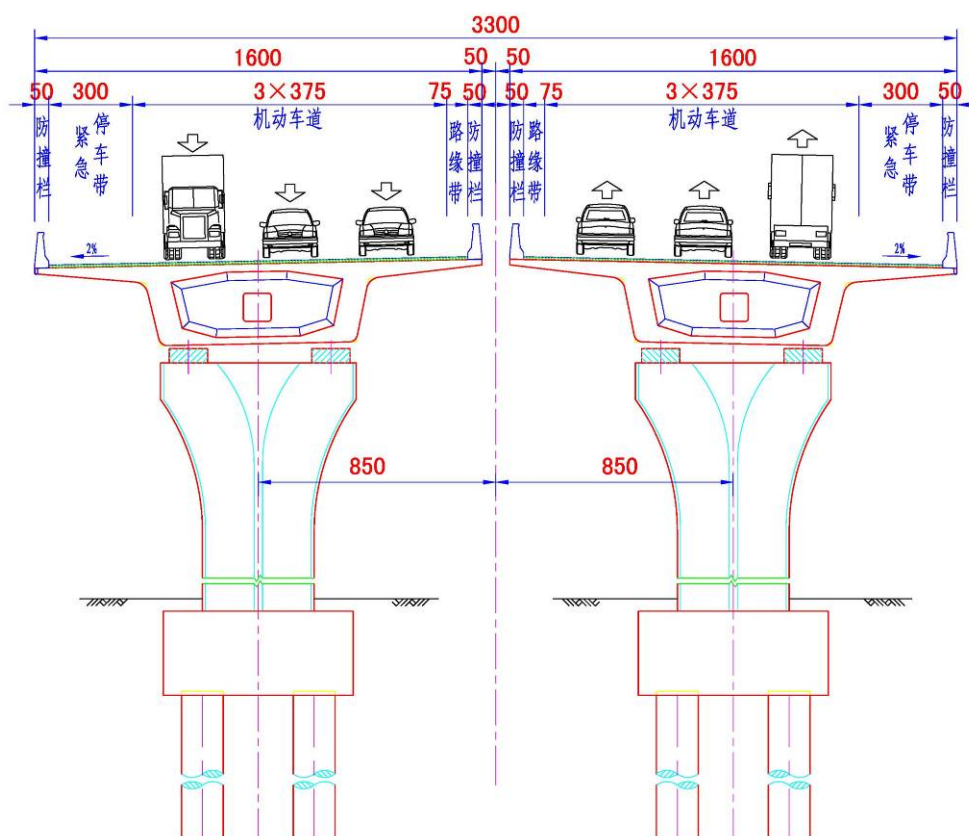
南、北引桥桥梁横断面图（单位：cm）
